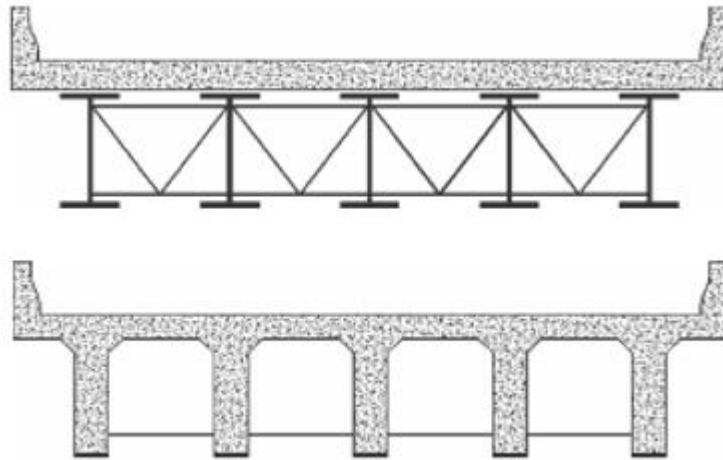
Seções transversais em vigas T. Fonte: Fu & Wang (2015)
